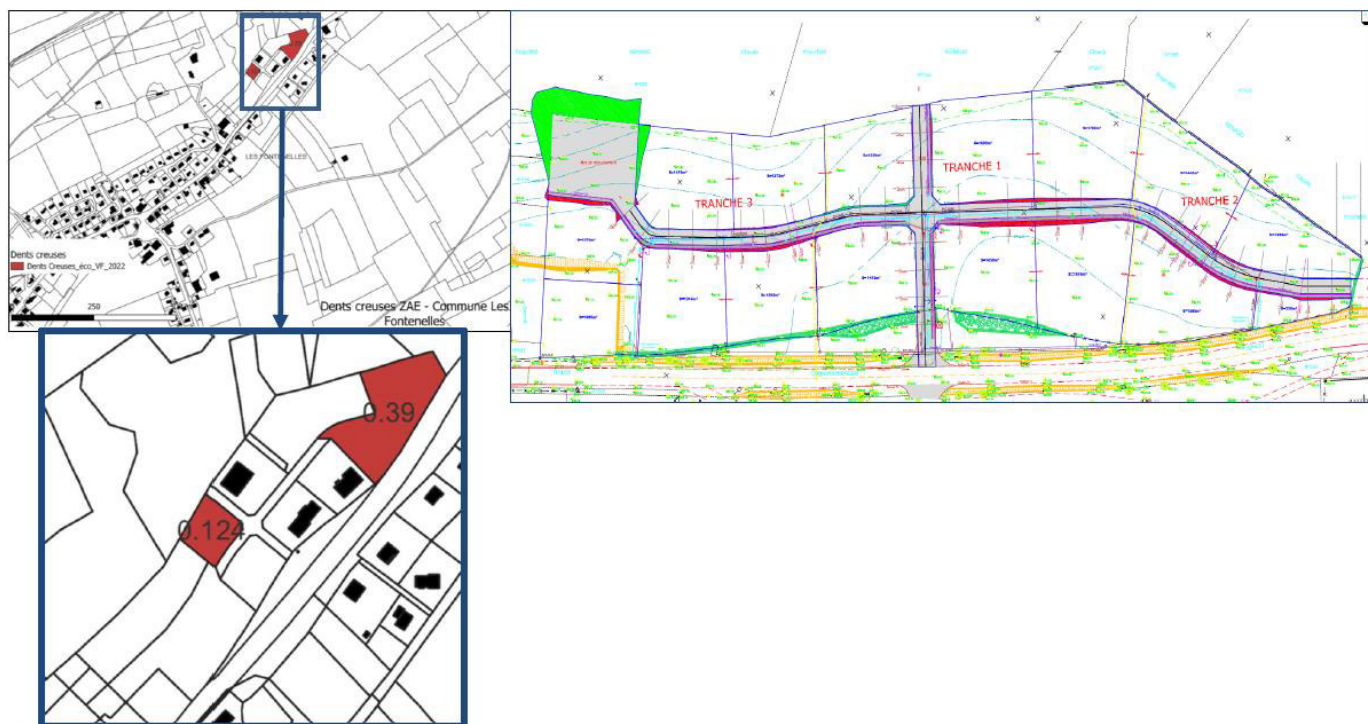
Plan d'aménagement et disponibilités de la ZAE "Champs Lovy" (Source: CCPR)
